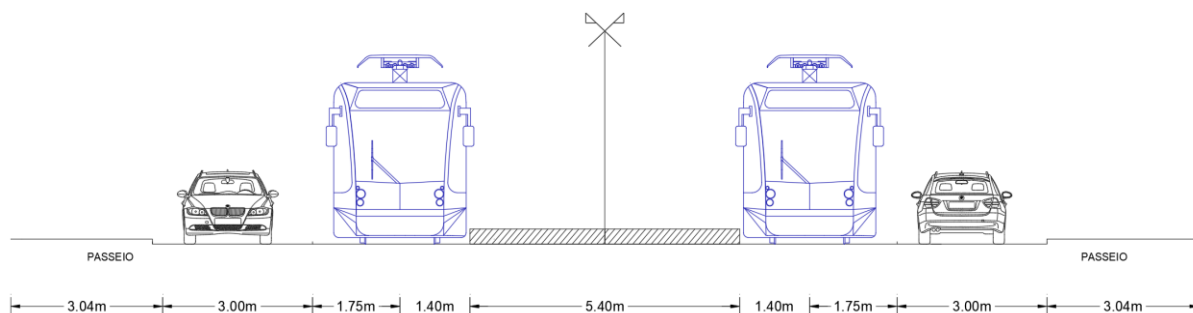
Perfil Transversal Tipo (Paragem – Cais Central – Tipo 2)
